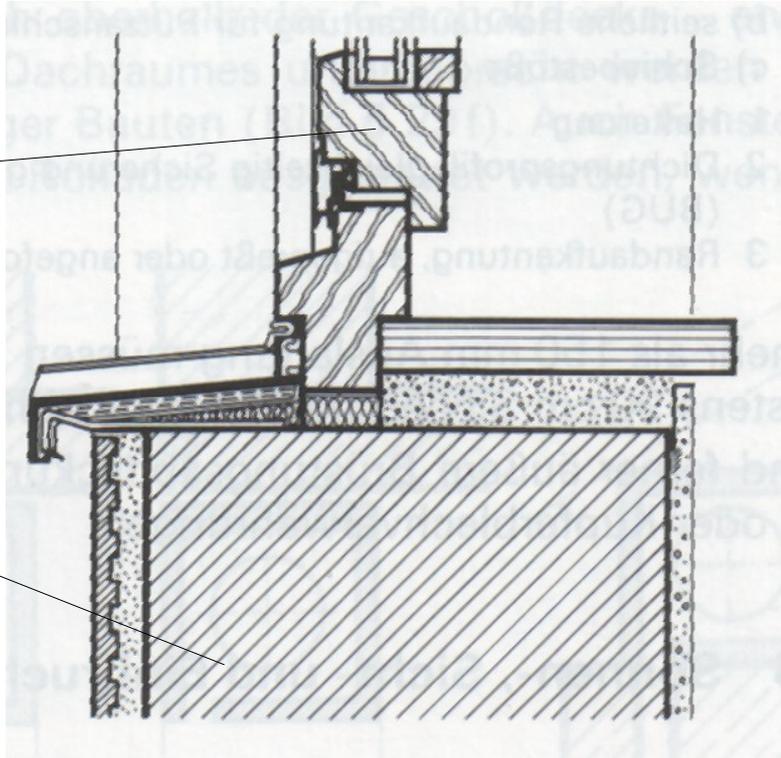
Konventionelles Fenster/Außenwand-Detail.²⁰⁰
